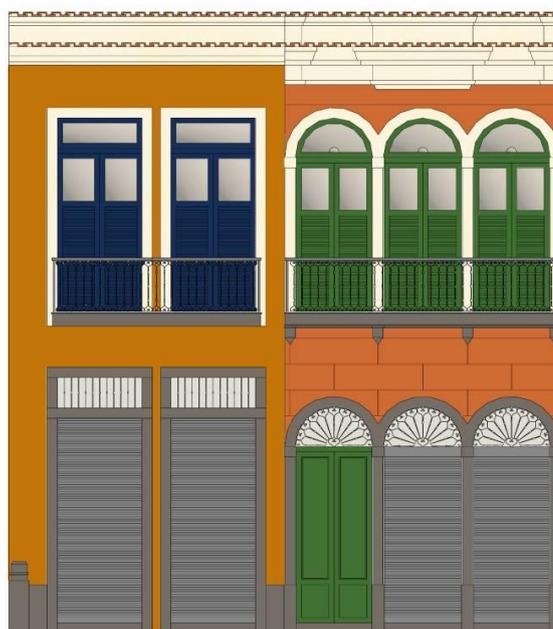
Fachada projetada para a Rua do Livramento 93 e 95
